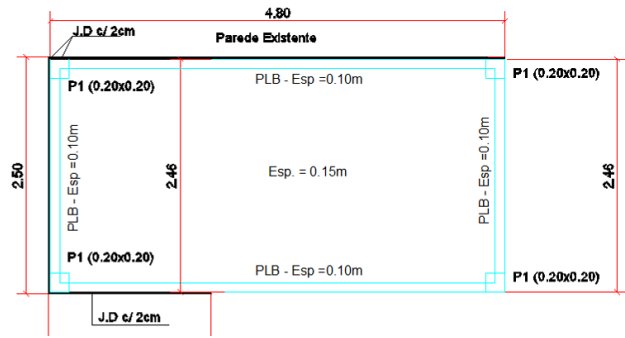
Planta estrutural da cobertura do edifício do gerador [AVicêncio C, 2017]
